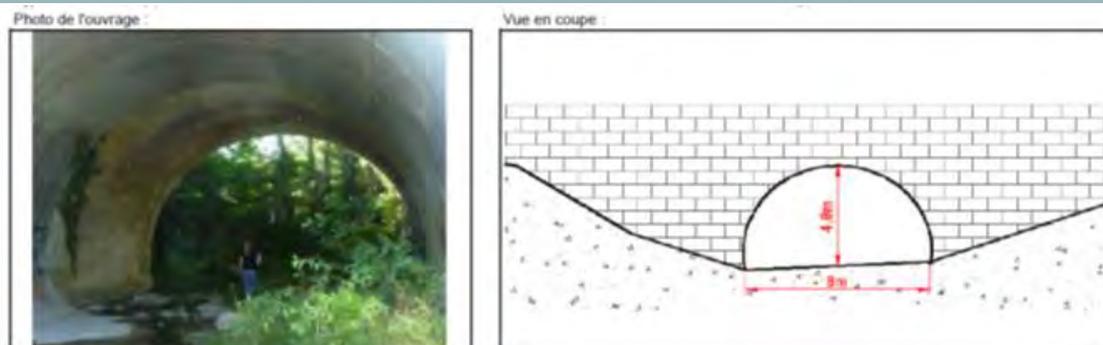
OUVRAGE ET COUPE DE L'OUVRAGE SOUS LA RD26E7
